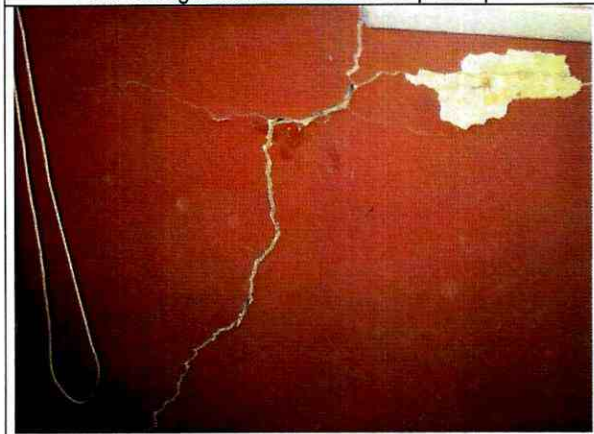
Grieta en muro del segundo piso, nororiental.
